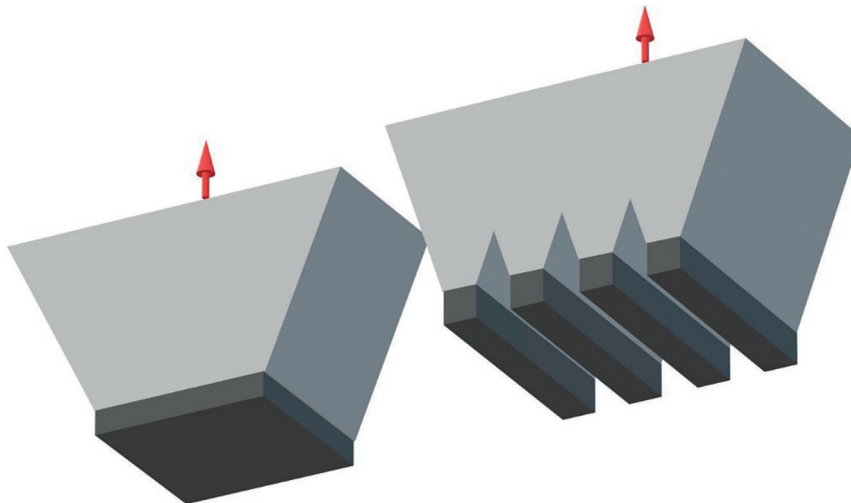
Тела выпирания для плитного и элементного фундаментов
